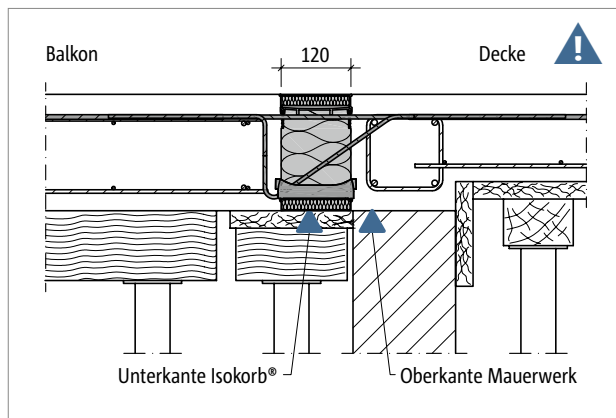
Schöck Isokorb® XT Typ KL: Ortbetonbalkon mit höhenversetzter Decke auf Mauerwerkswand
